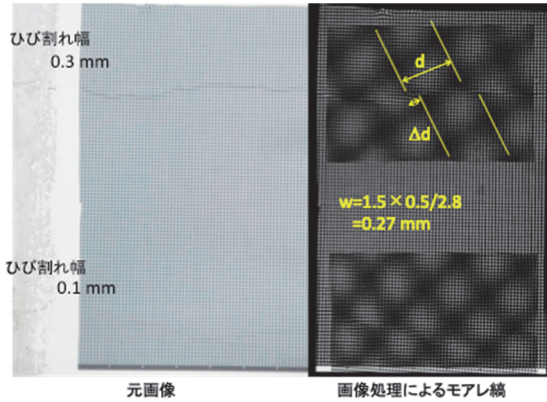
モアレ縞によるひび割れ幅の算出例
